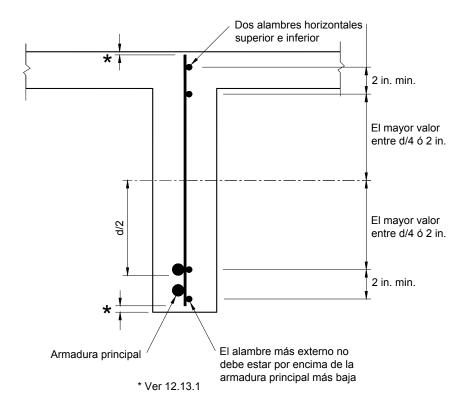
Detalles de anclaje para los estribos de una rama realizados con malla de acero soldada (12.13.2.4)
